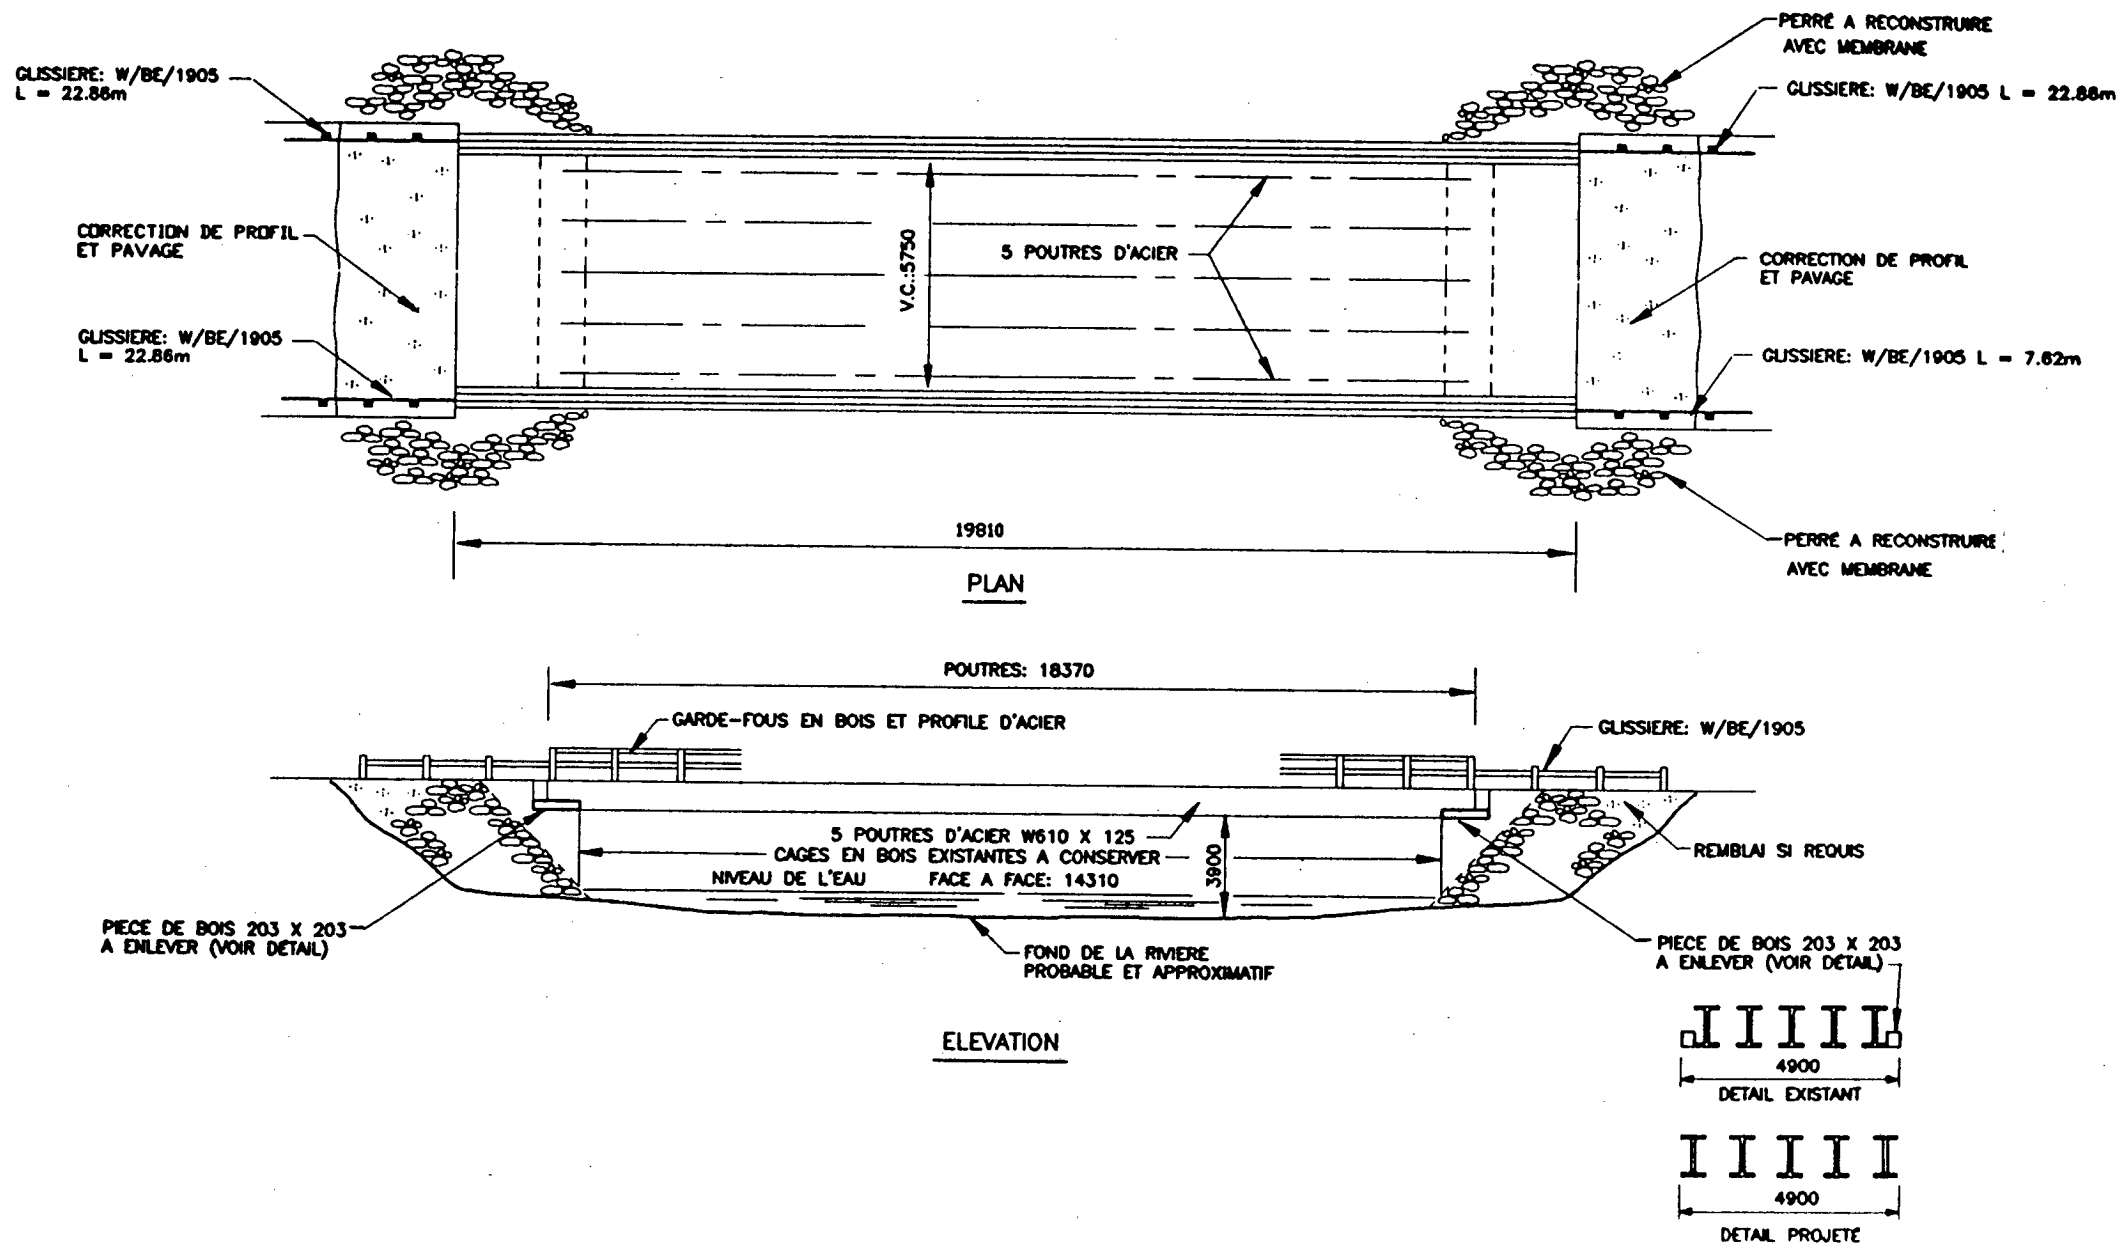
PLAN D'ENSEMBLE DES TRAVAUX; PONT PATRICK ROSE
